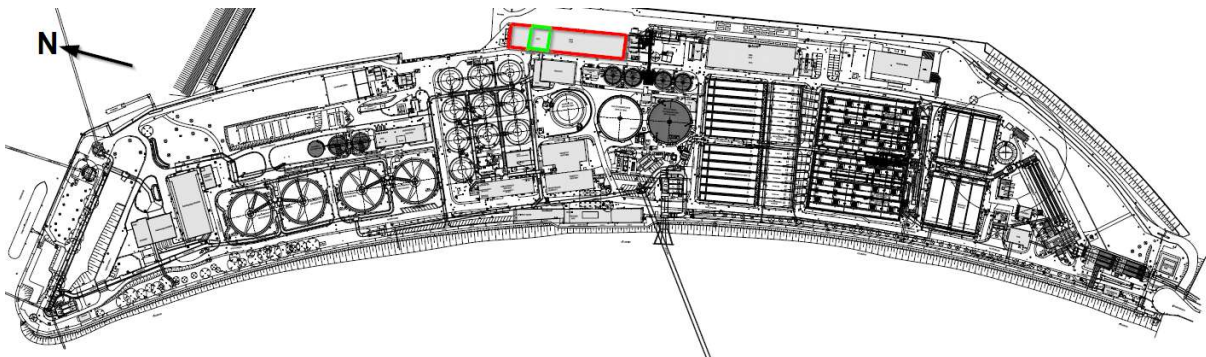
Übersichtslageplan Klärwerk (rot: KETA, grün: geplante neue Teilaufstockung)
